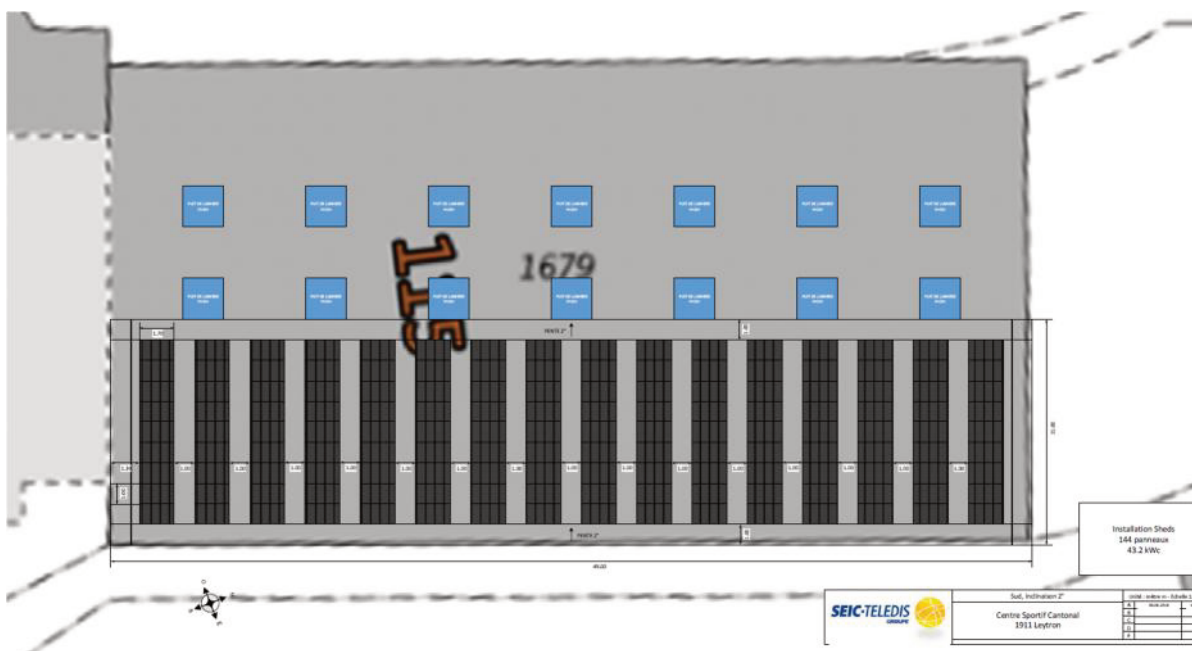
Calepinage des modules en portrait, façade du toit en haut du plan
